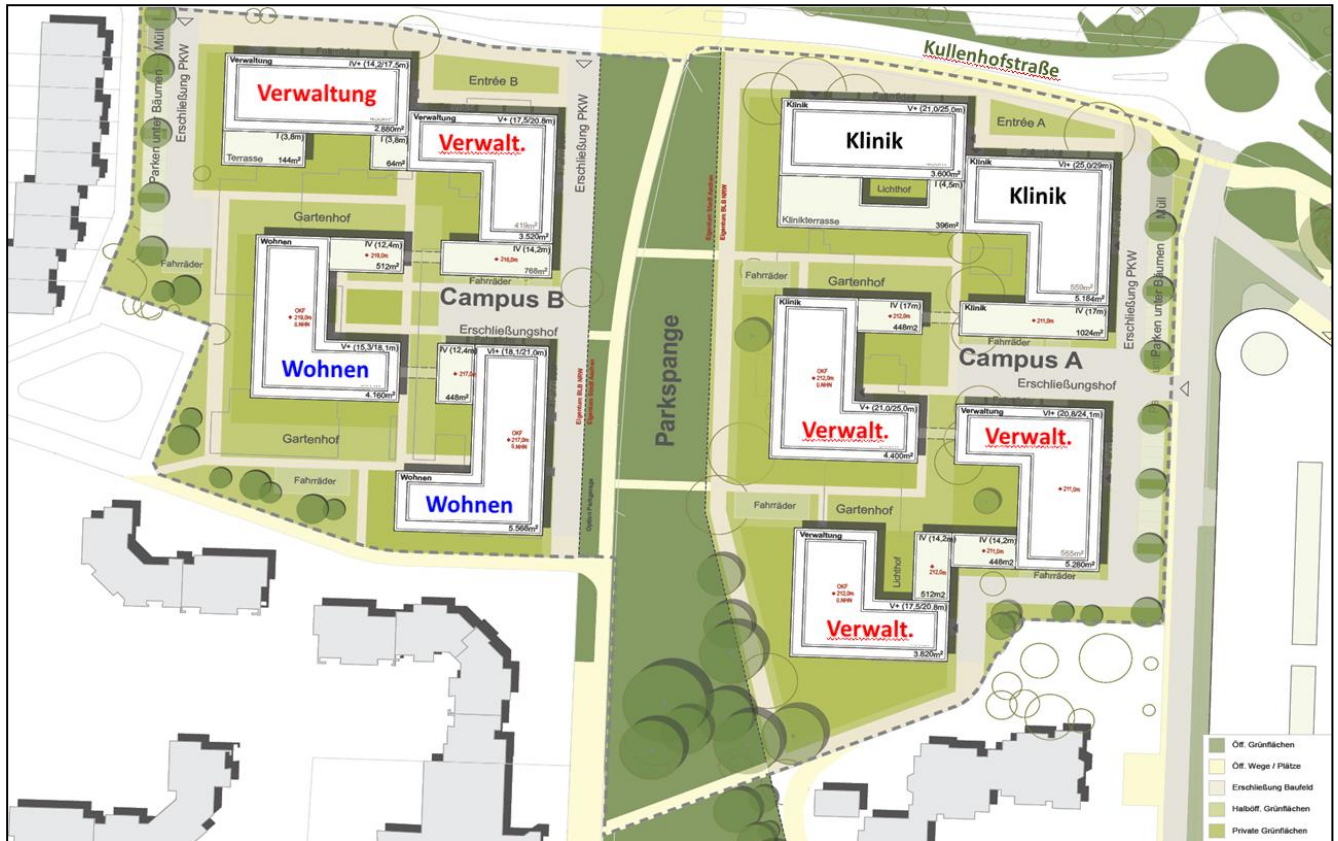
Städtebaulicher Vorentwurf für das Plangebiet (Stand 17.08.2016)
